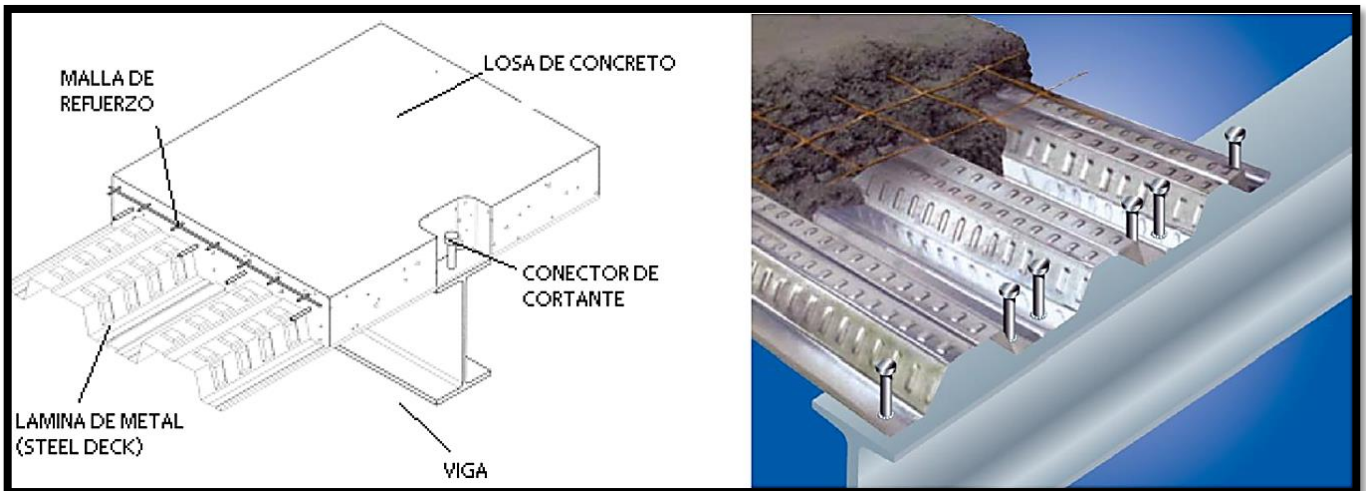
Sistema de entrepiso utilizando una losa con placa colaborante o losa compuesta
